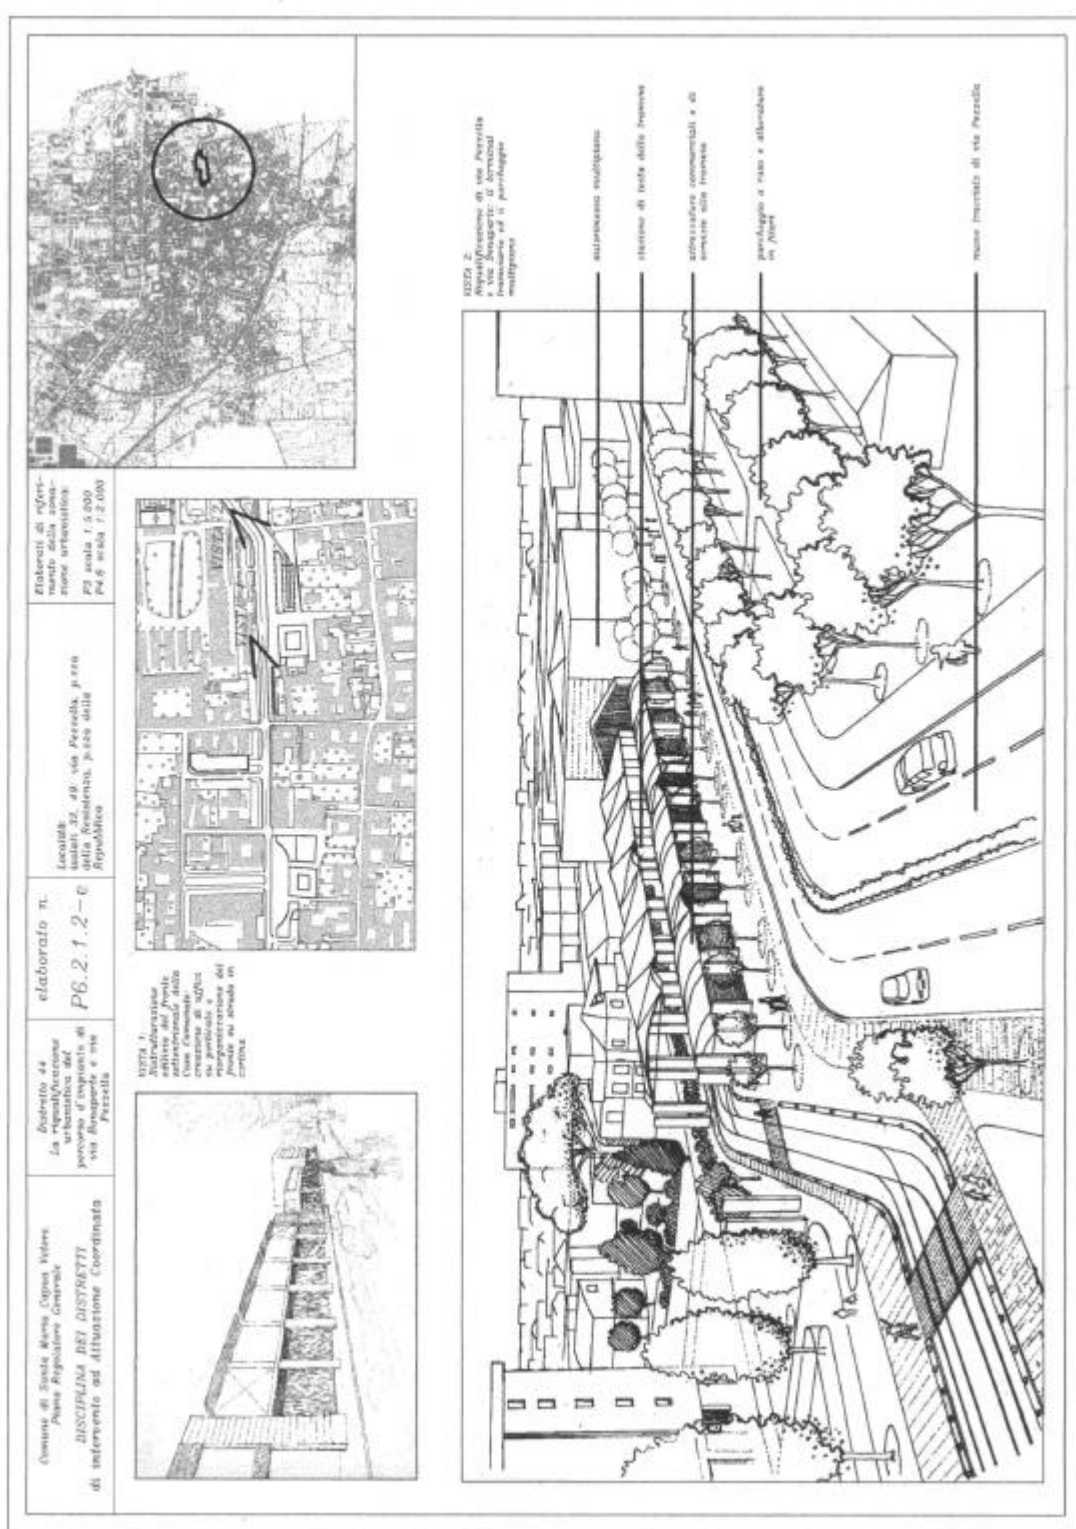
l'innovazione funzionale nel perimetro della zona di interesse storico: ipotesi di assetto tridimensionale di Via Bonaparte e Via Pezella
